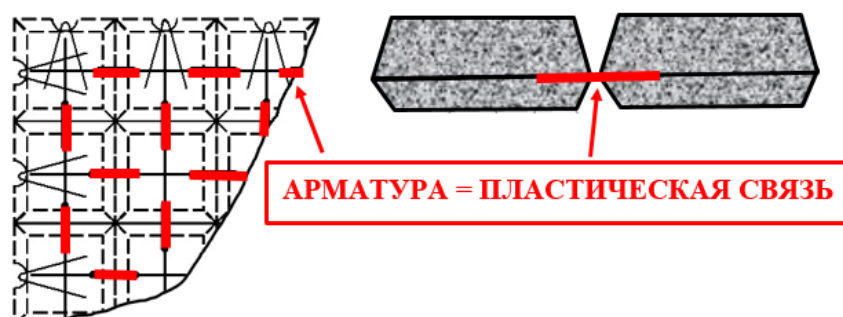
Конструкция гибкой сборной железобетонной плиты
